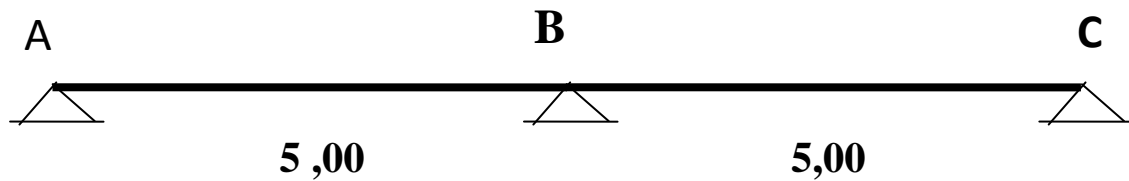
Schéma statique de la poutrelle Type T1 (étage courant, RDC et sous sol).
